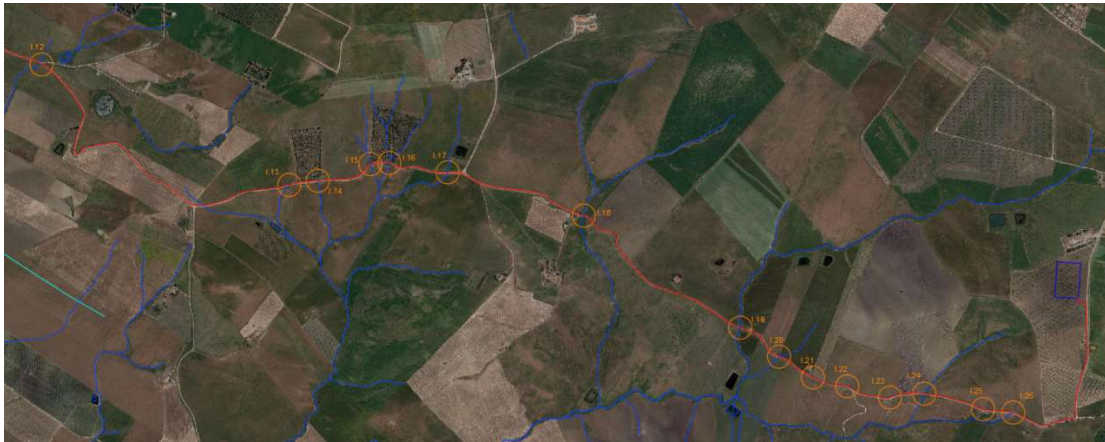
Individuazione Planimetrica delle Interferenze – 2
